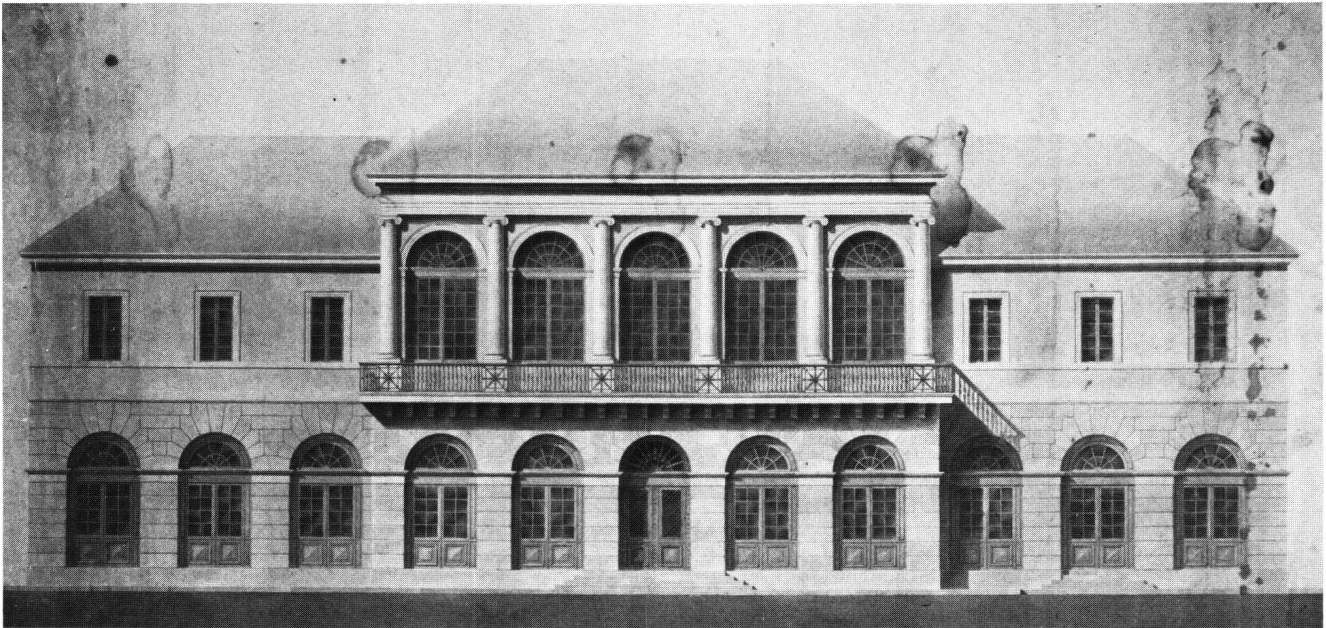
M. Berri, Fassadenentwurf, 1824. Staatsarchiv Basel-Stadt.
